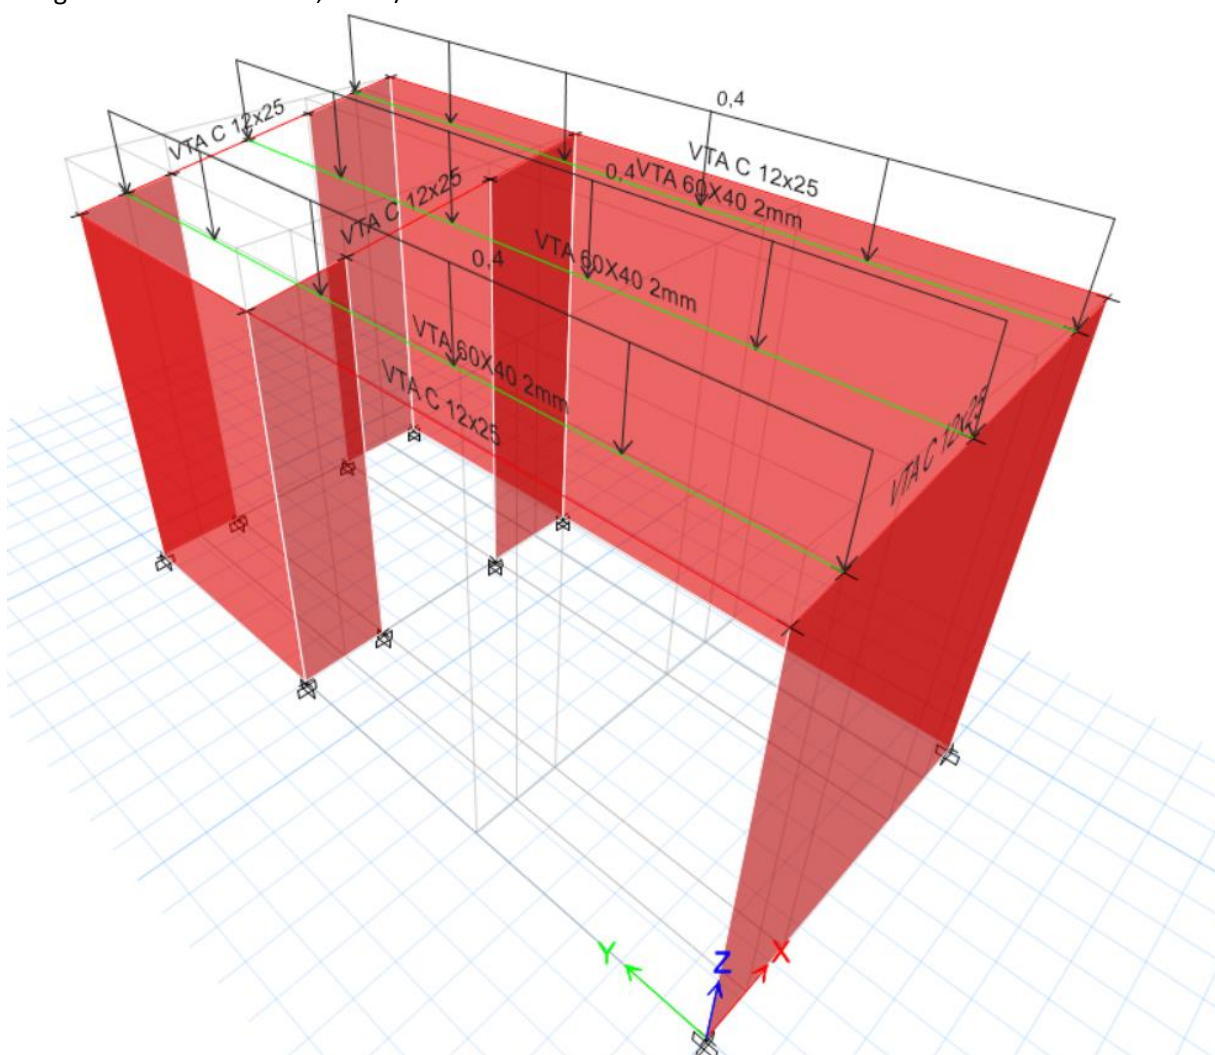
Carga muerta distribuida (W) [kN, m, C]
